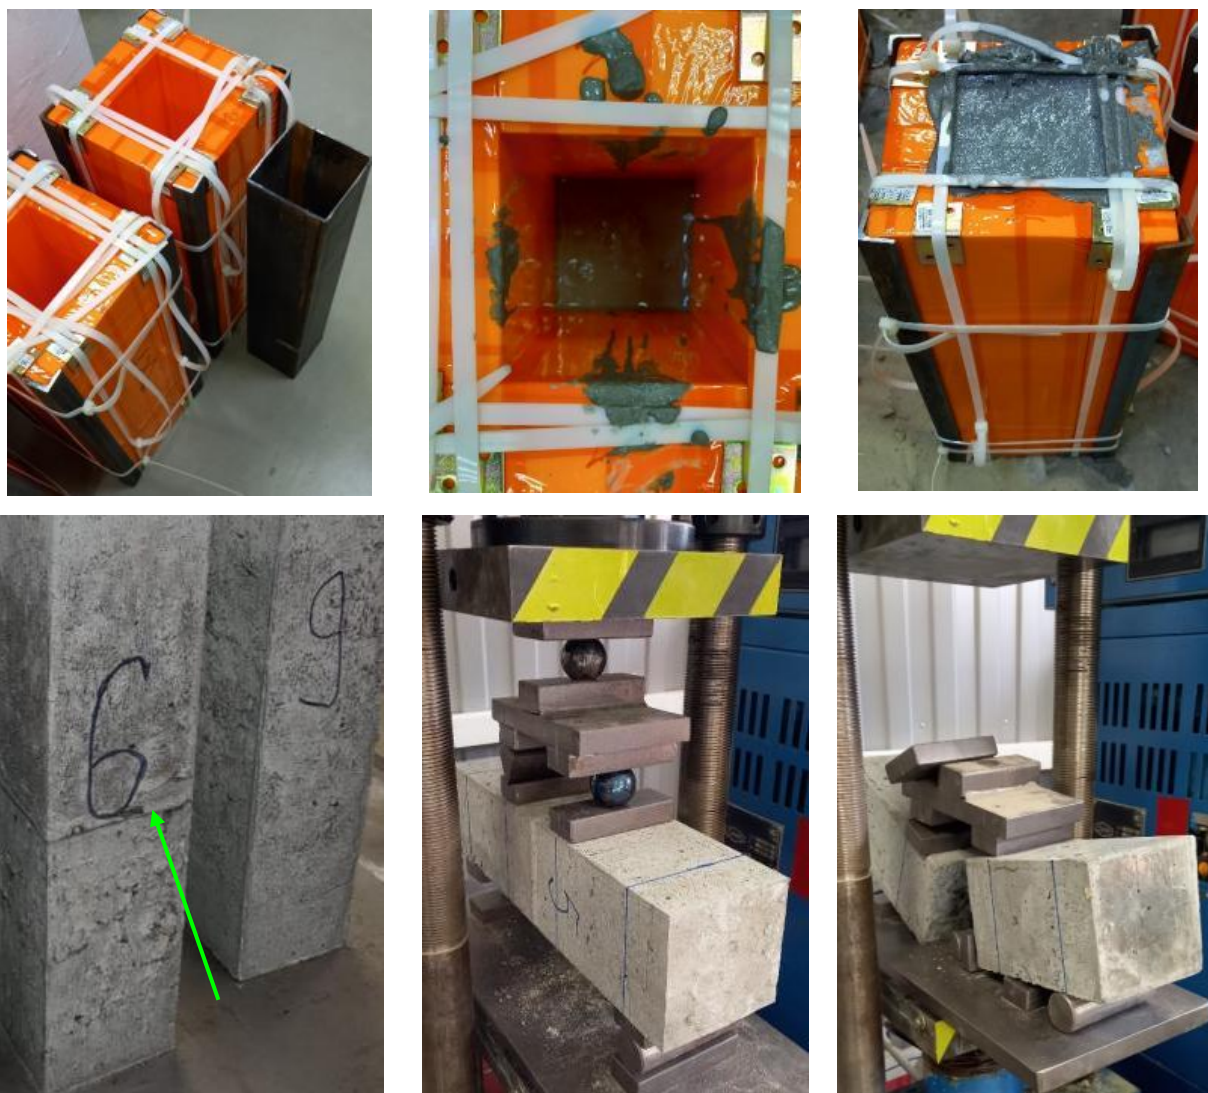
Этапы послойного изготовления призм и испытания на изгиб.
